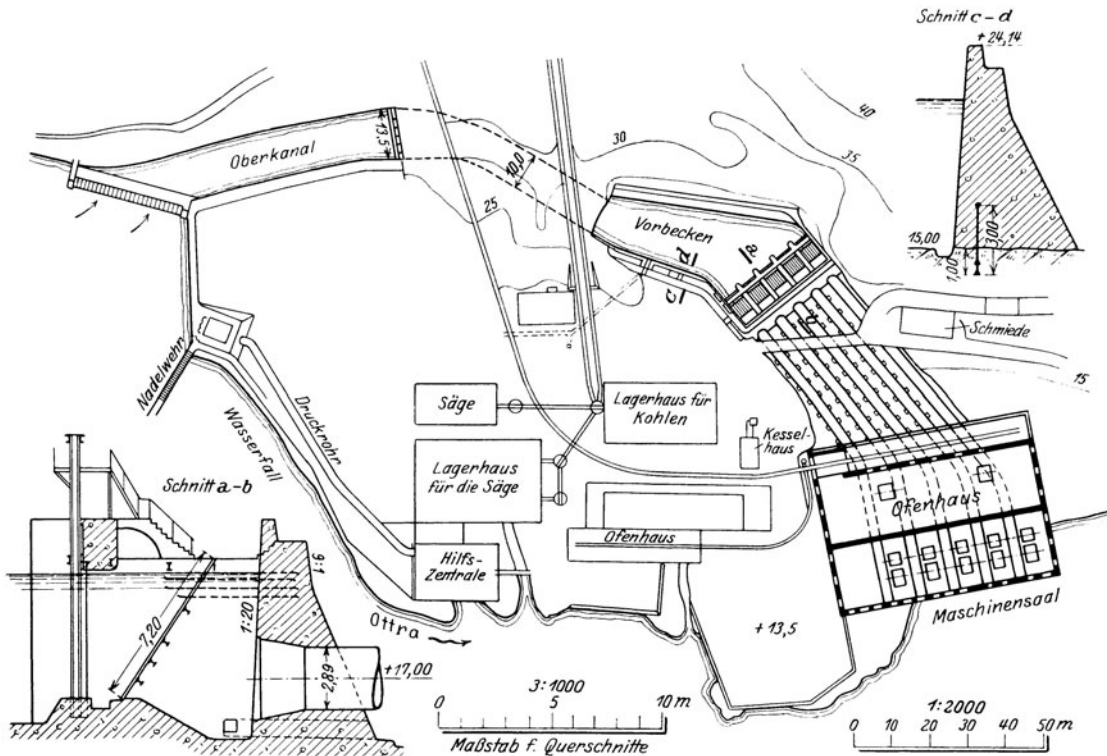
Vigelandsbruk. Lageplan. (Schweiz. Bzg.)
